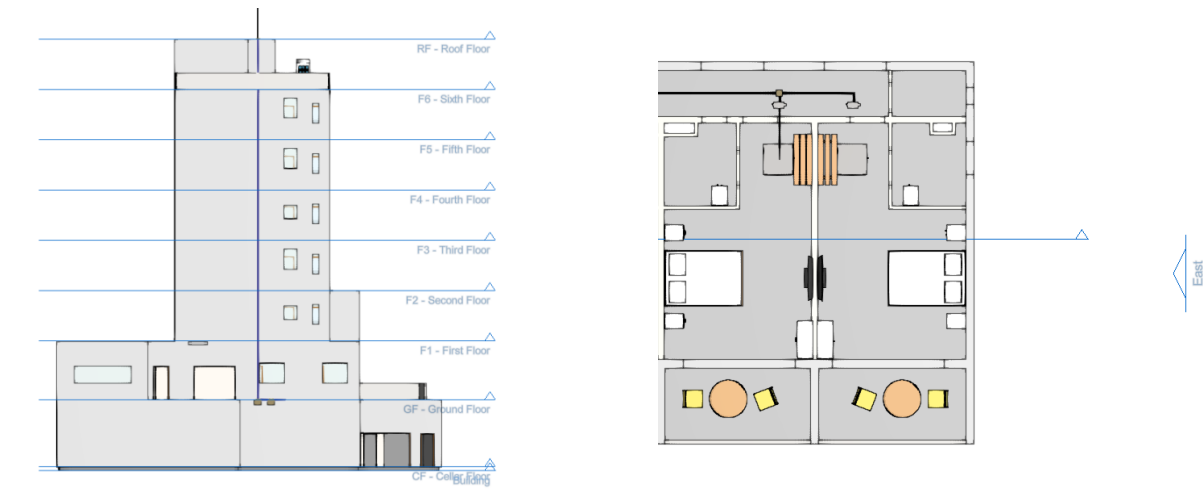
Vista di prospetto e riferimento in pianta (Open BIM Lighting)
